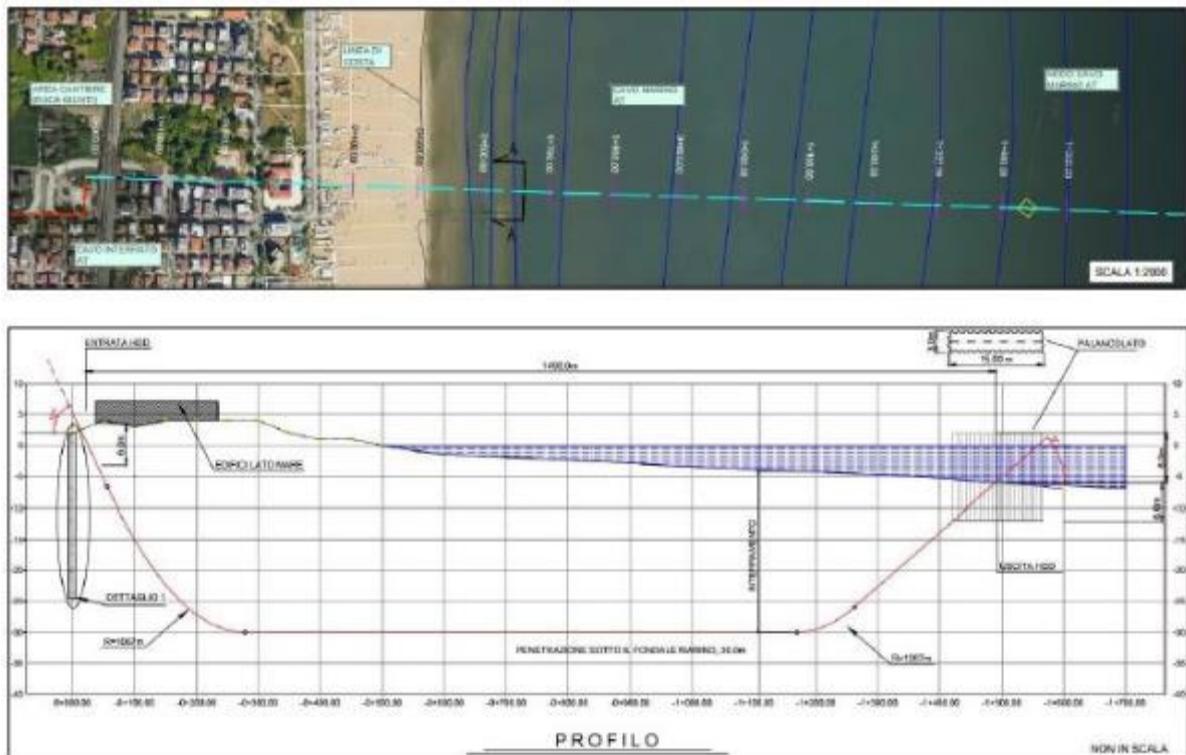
Planimetria e sezione attraversamento terra – mare in HDD
